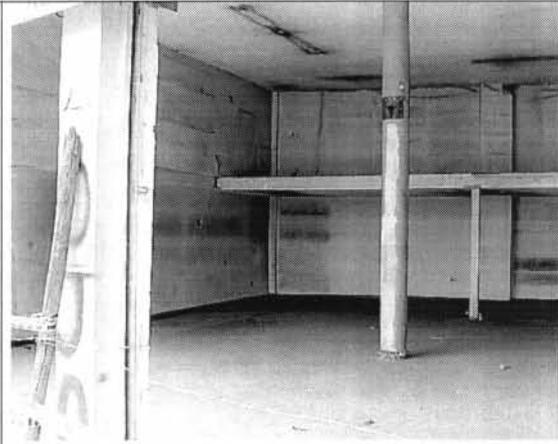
Deterioro interior de la edificación. Sin daño observable.
